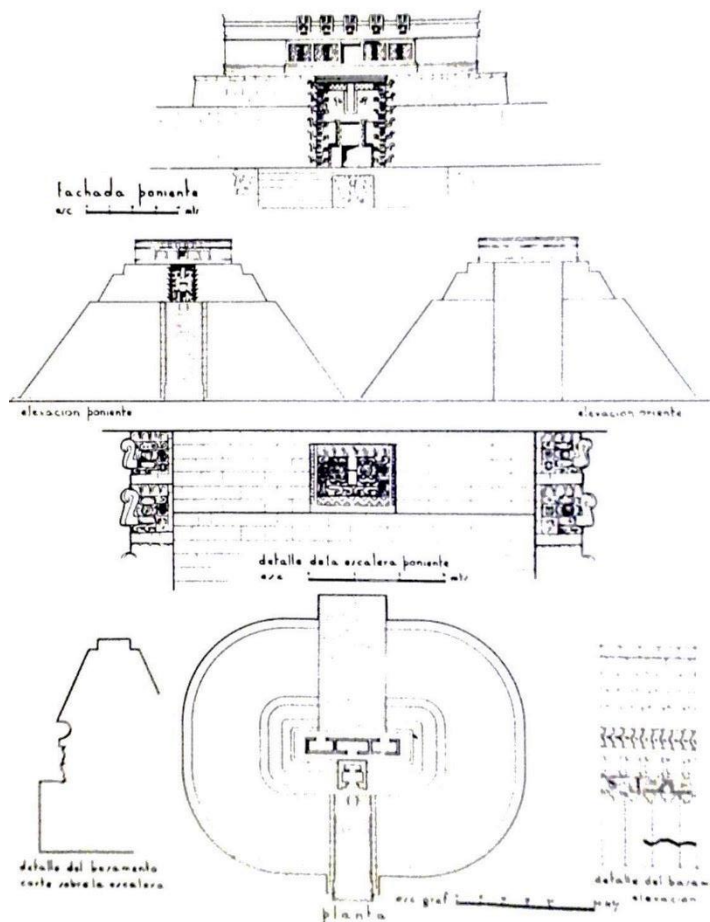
Marquina Ignacio. Pirámide del Adivino. Plano Fachadas y detalles. 2016. México. INAH. 1999. pág. 769.
